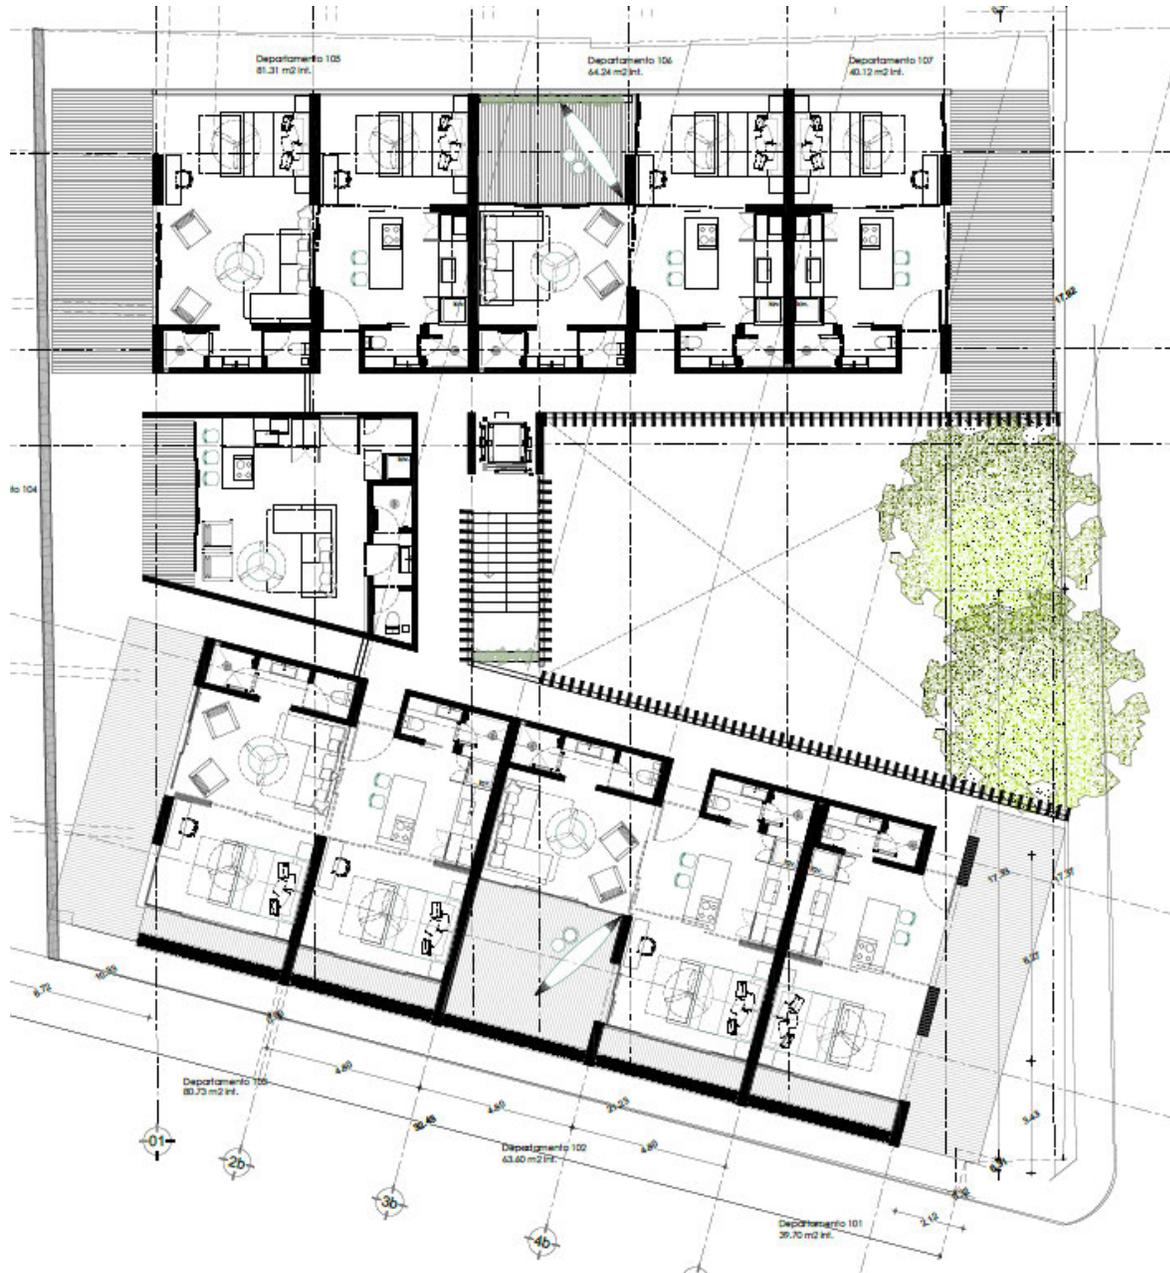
Planta nivel 1, Fuente: Plano Arquitectónico.
